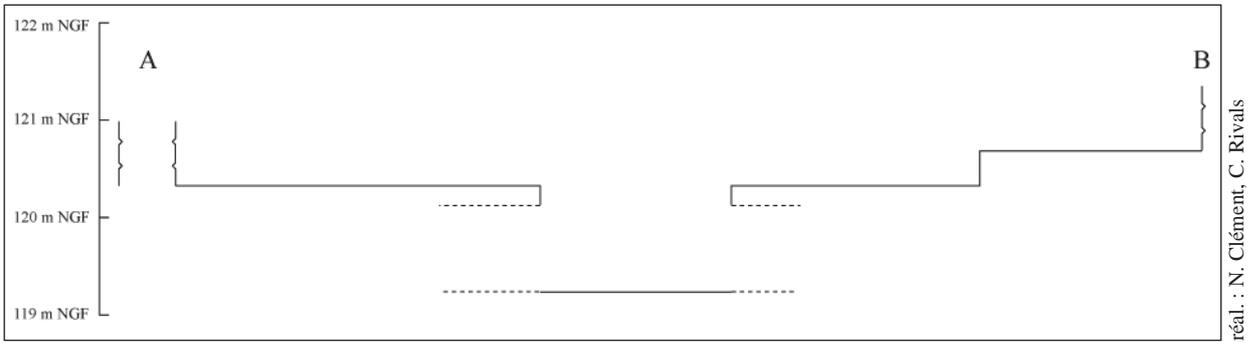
coupe [AB] (nord-est / sud-ouest) du rez-de-chaussée
